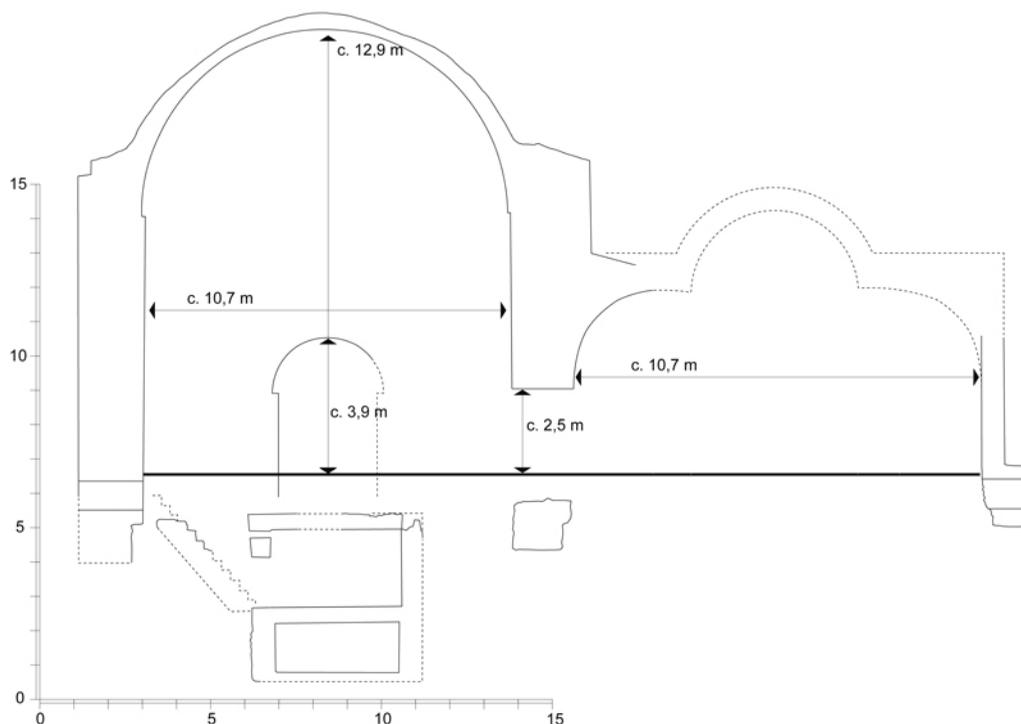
Sección esquemática de las salas de la cúpula (7) y cuadrilobulada (8). Posición aproximada del pavimento original indicada con línea gruesa (Remolà, a partir de Schlunk y Hauschild 1962: fig. 7).
